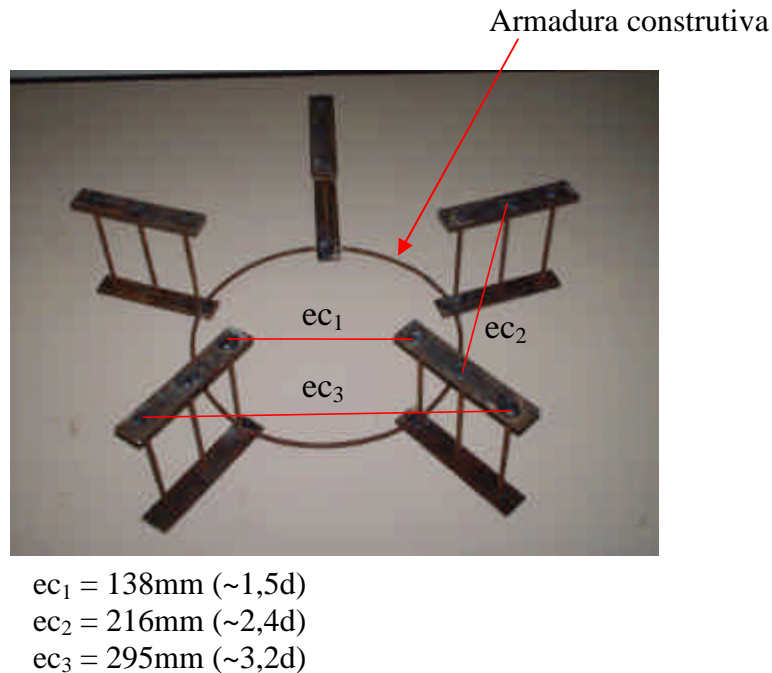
Fotografia da distribuição da armadura de cisalhamento na laje L8.
